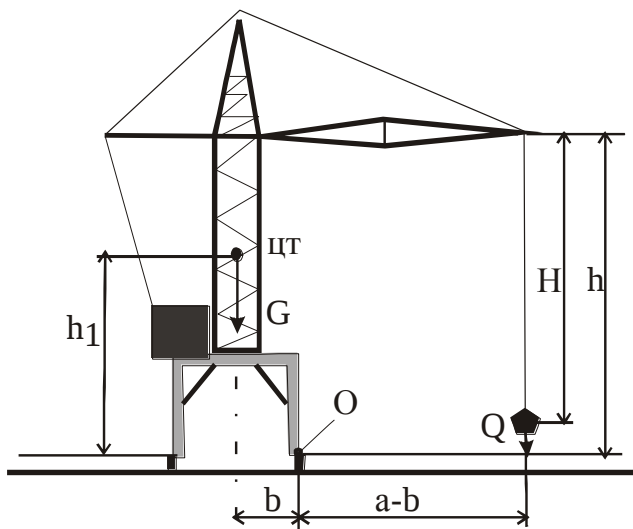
Расчетная схема грузовой устойчивости башенного крана
